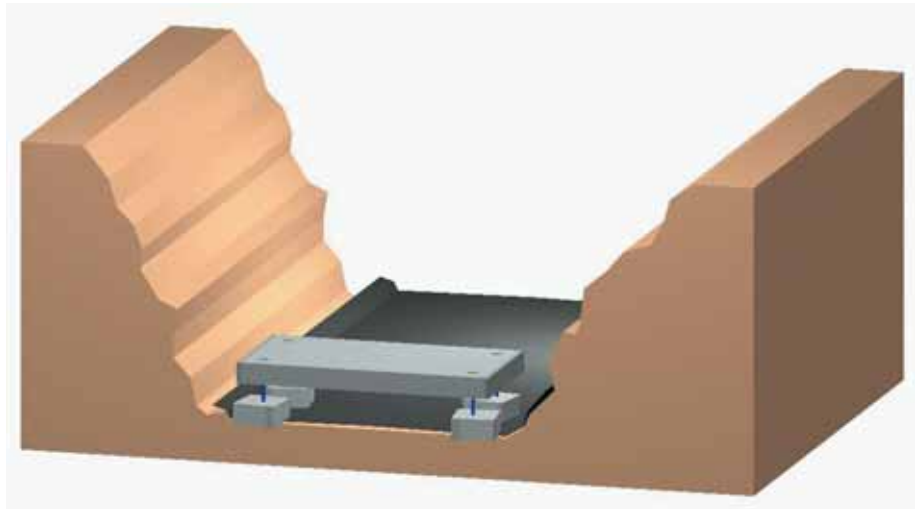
Fundering voordat de tussenruimte met beton wordt gevuld. Onder de betonnen platen is met een L-vormig afsluitstuk een verbrede voet gecreëerd, die ook met beton wordt gevuld
